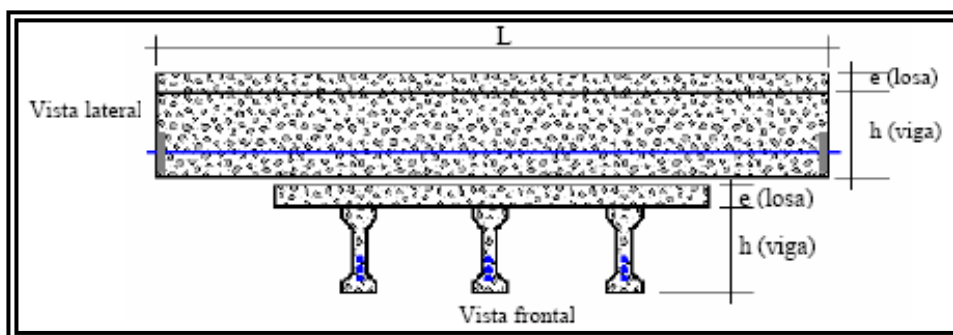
29 Puente con vigas de concreto pretensado⁵⁴.
